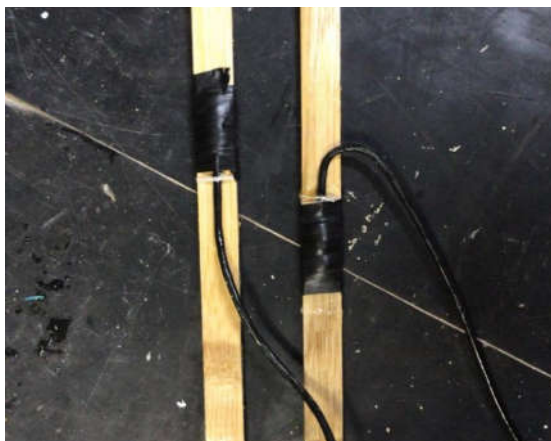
Posicionamento dos extensômetros na armadura treliçada
